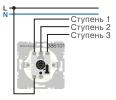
Трехступенчатый выключатель с нулевым положением [№ для заказа 3861]/трехступенчатый выключатель без нулевого положения [№ для заказа 386101]
